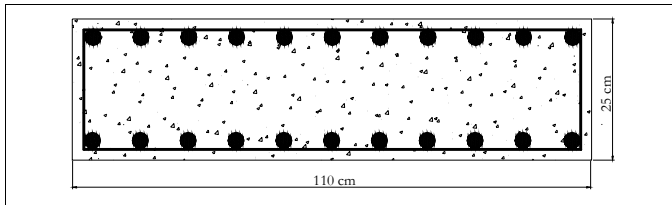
Caso 1: Arranjo das armaduras na seção transversal do pilar P1.
